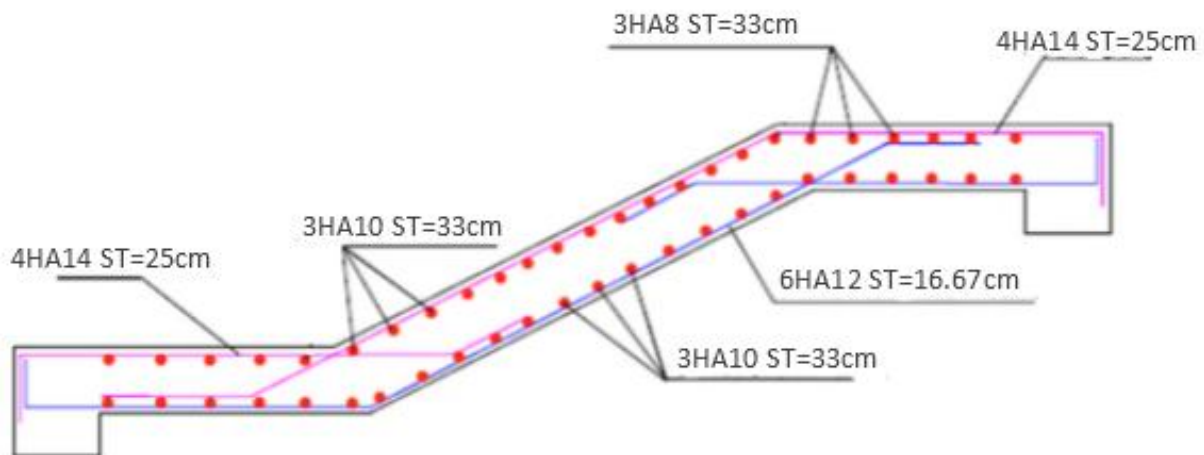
Schéma de ferrailage de l'escalier RDC
